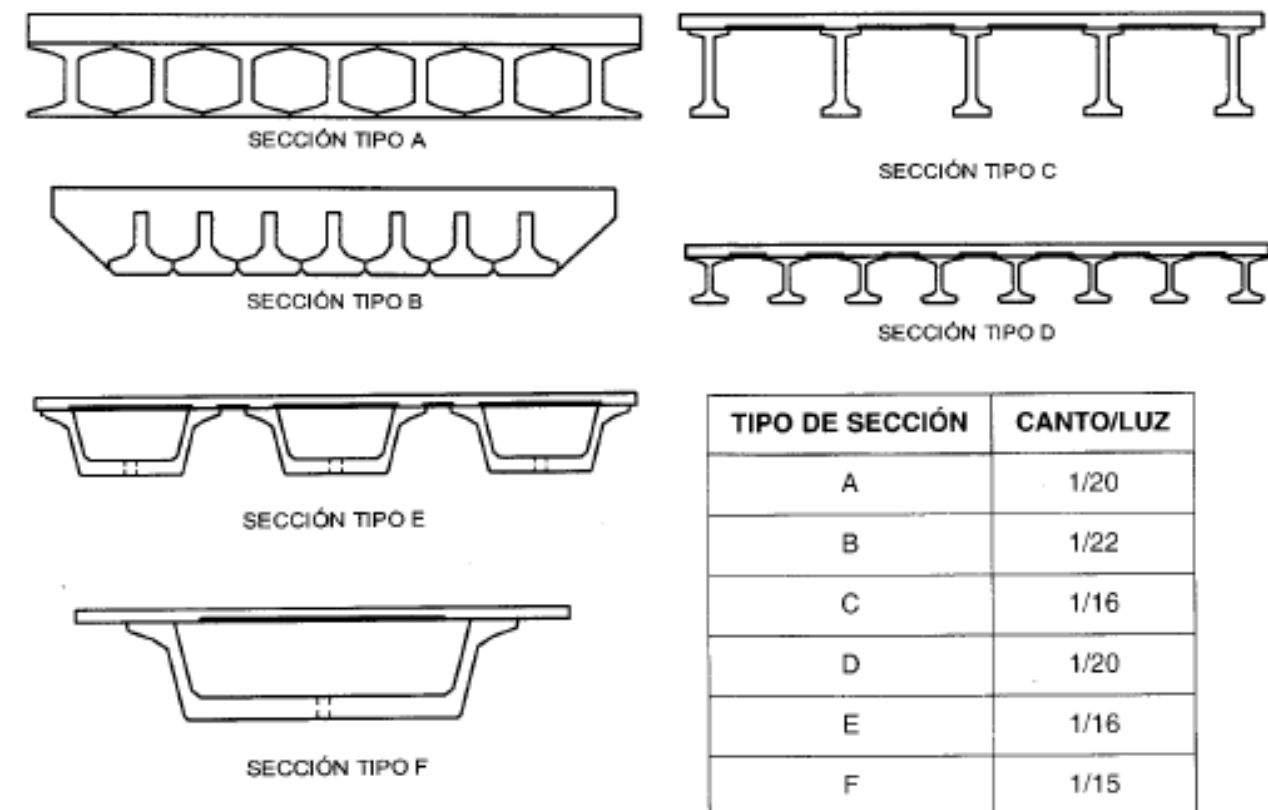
Tipos de secciones en vigas prefabricadas y esbelteces.
